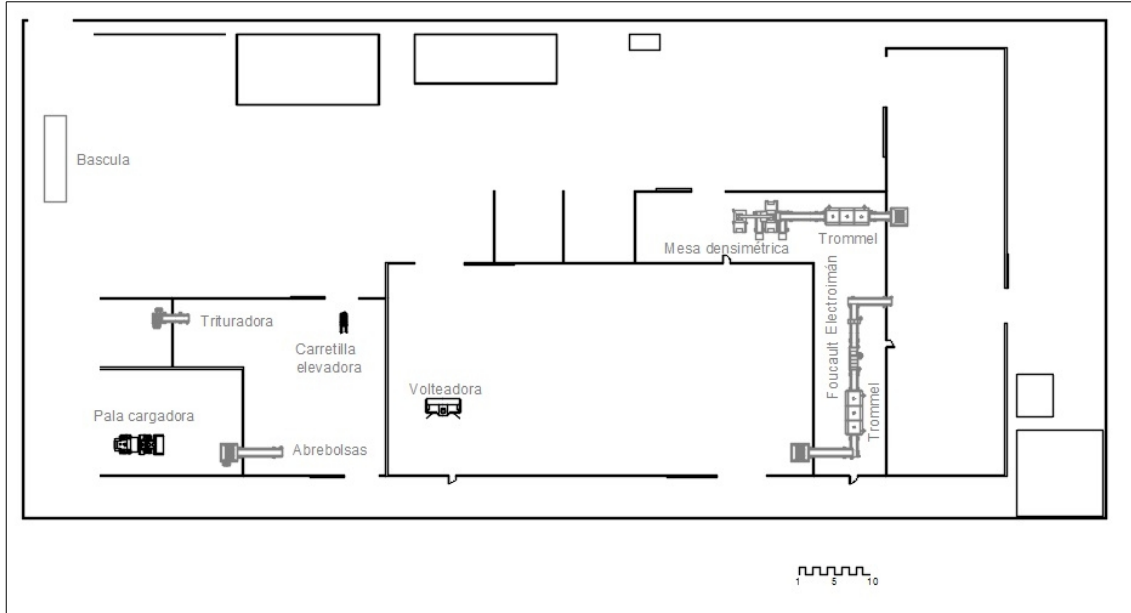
Plano de la distribución de maquinaria en la planta. Fuente propia.
